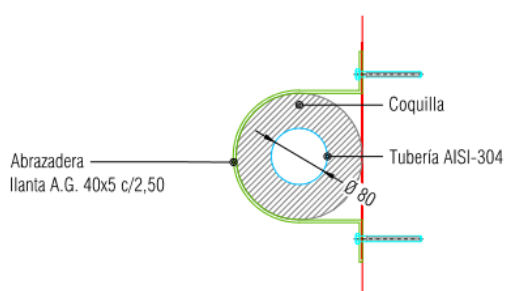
Detalle paso ramal PE90 anclado a estribo A-15
